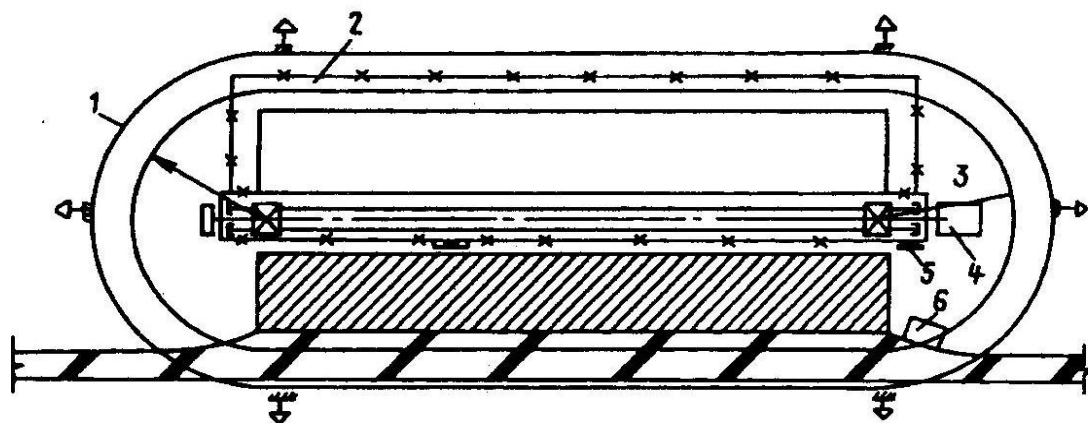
Схема расположения опасных зон при работе башенного крана: 1 – граница опасной зоны при перемещении груза; 2 – временное ограждение; 3 – башенный кран; 4 – место нахождения контрольного груза; 5 – шкаф электропитания; 6 – площадка для раствора
